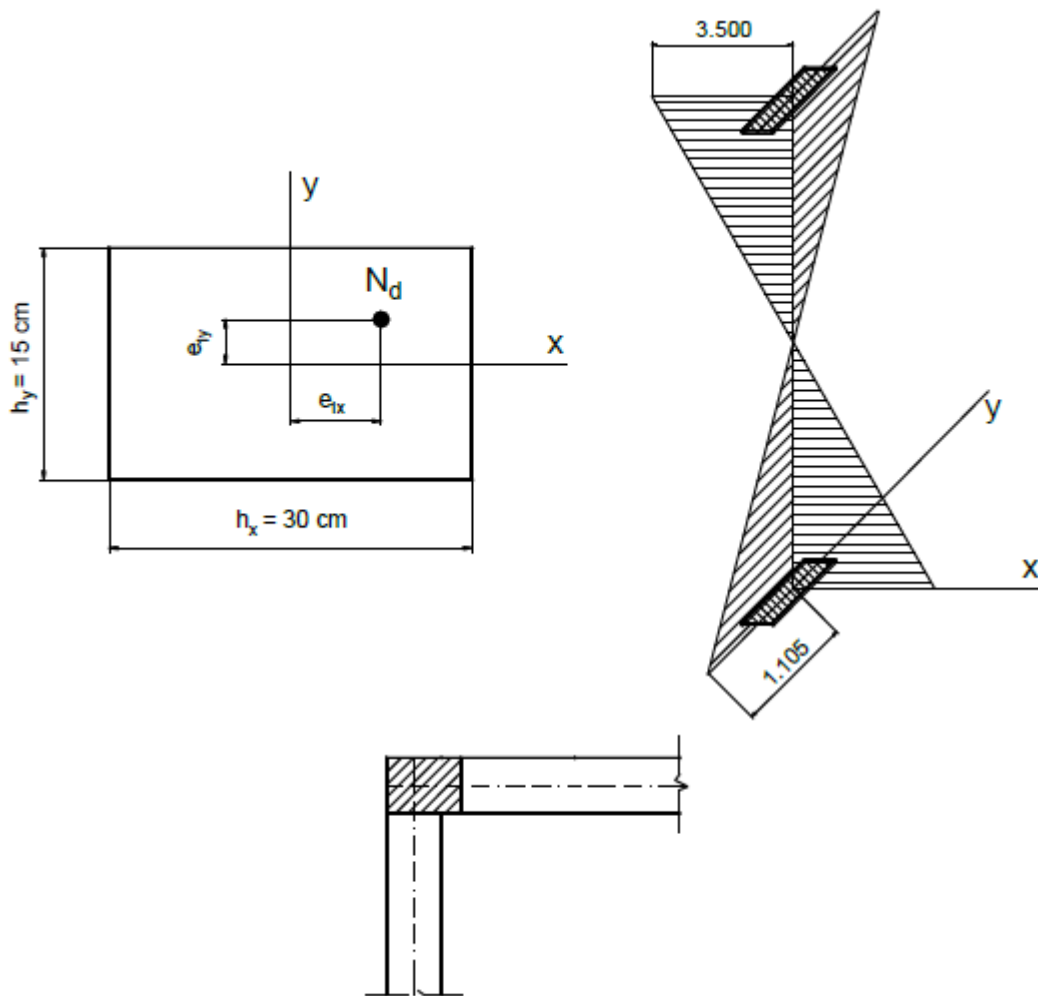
Arranjo estrutural do pilar na planta de fôrma, dimensões da seção transversal, posição do ponto de aplicação da força normal N_d e momentos fletores de 1ª ordem (kN.cm) nas direções x e y .
